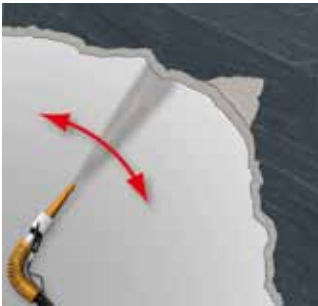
1a capa hormigón proyectado - 1a estabilización de excavación y puente adhesivo para 2ª capa de hormigón proyectado
